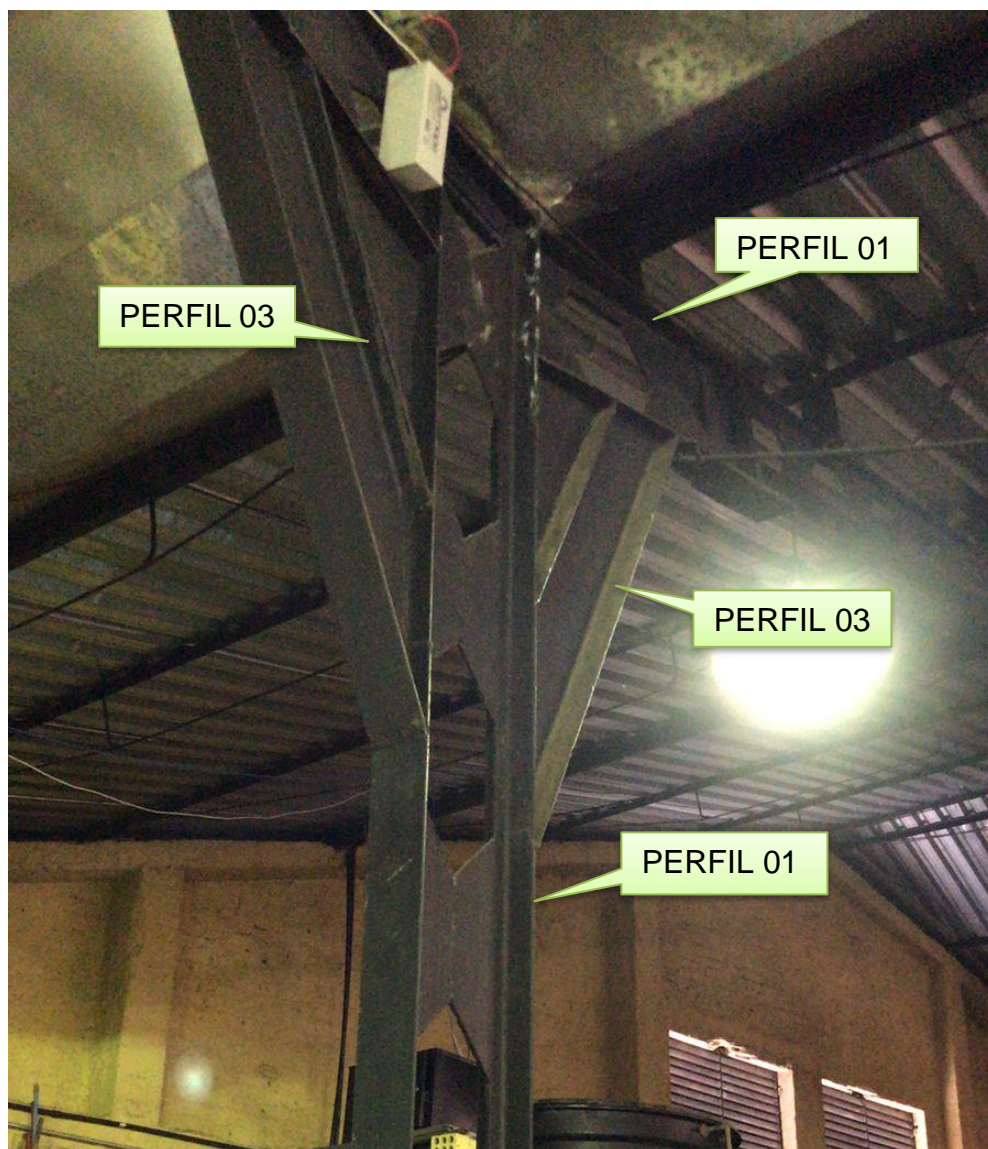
LIGAÇÃO ENTRE PILAR DO MEIO E TESOURAS
